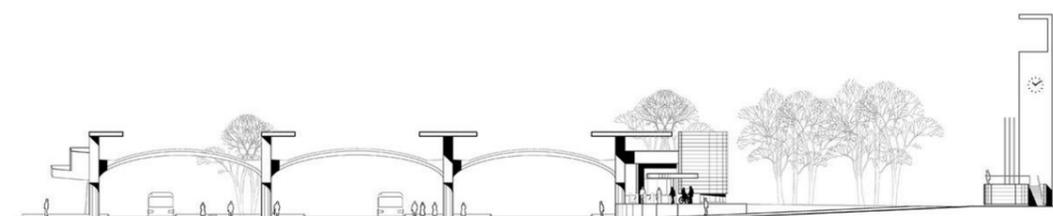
FACHADA. FONTE: ARCHDAILY.
